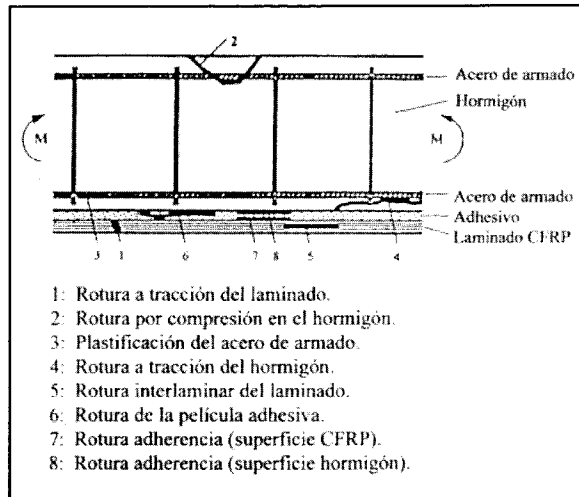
Sección longitudinal de una viga reforzada con láminas de materiales compuestos. Modos de rotura, Meier (92).
